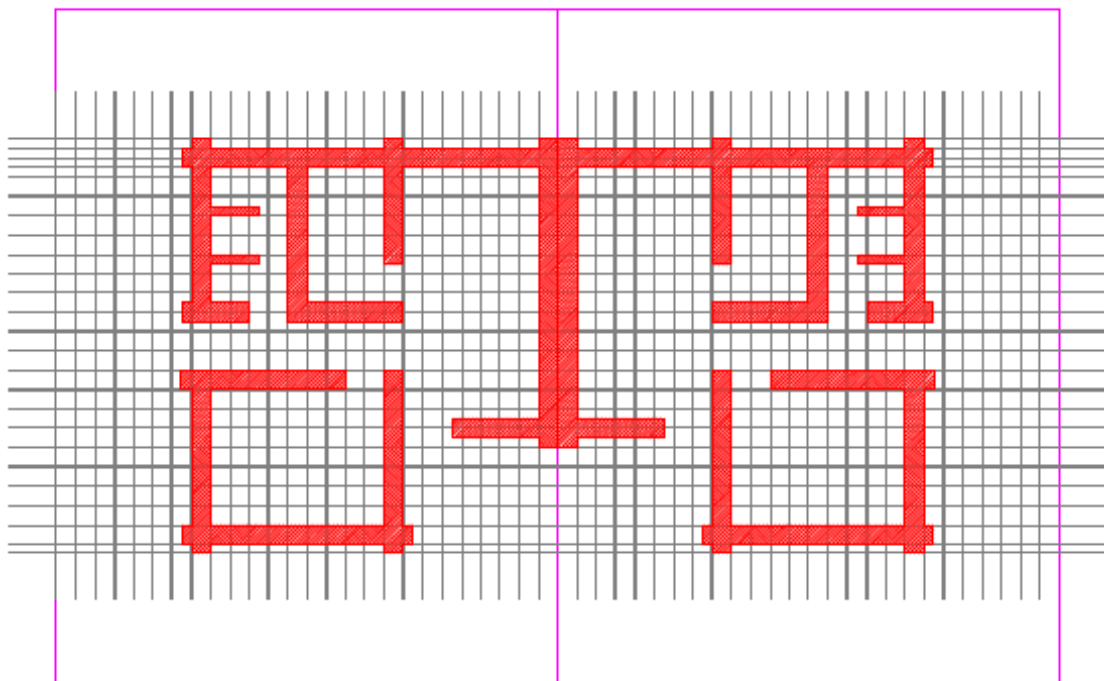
Planta malla para las viviendas modulares emergentes.
